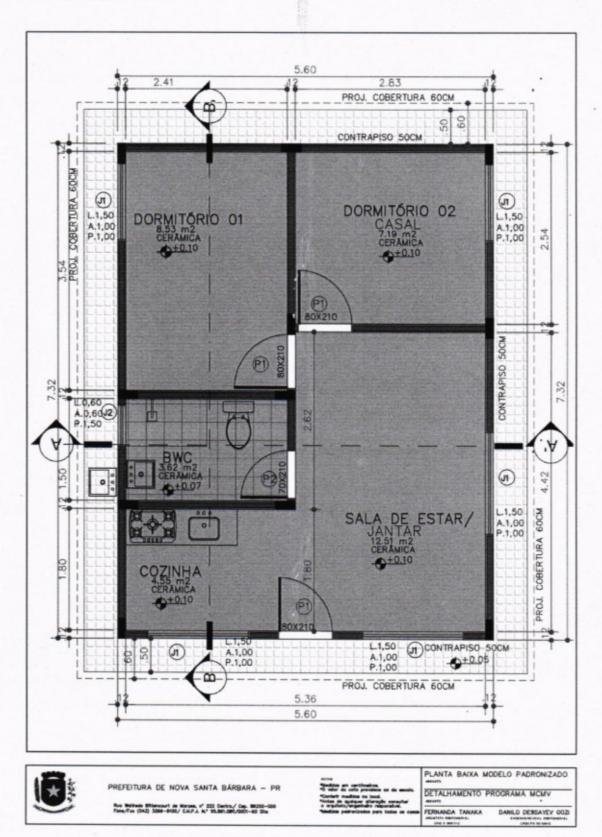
Planta baixa - arquitetônica Fonte: o próprio autor
